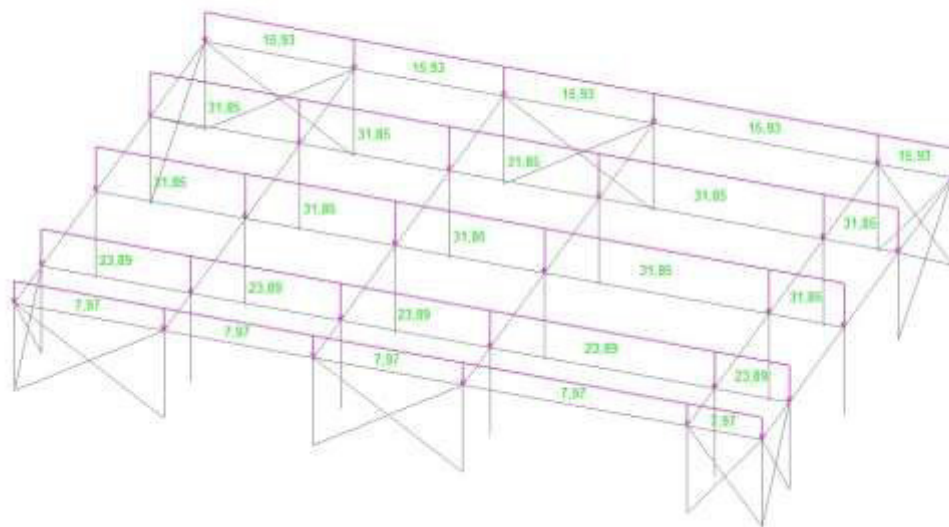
Общий вид загрузки от веса перекрытия и кровли.
